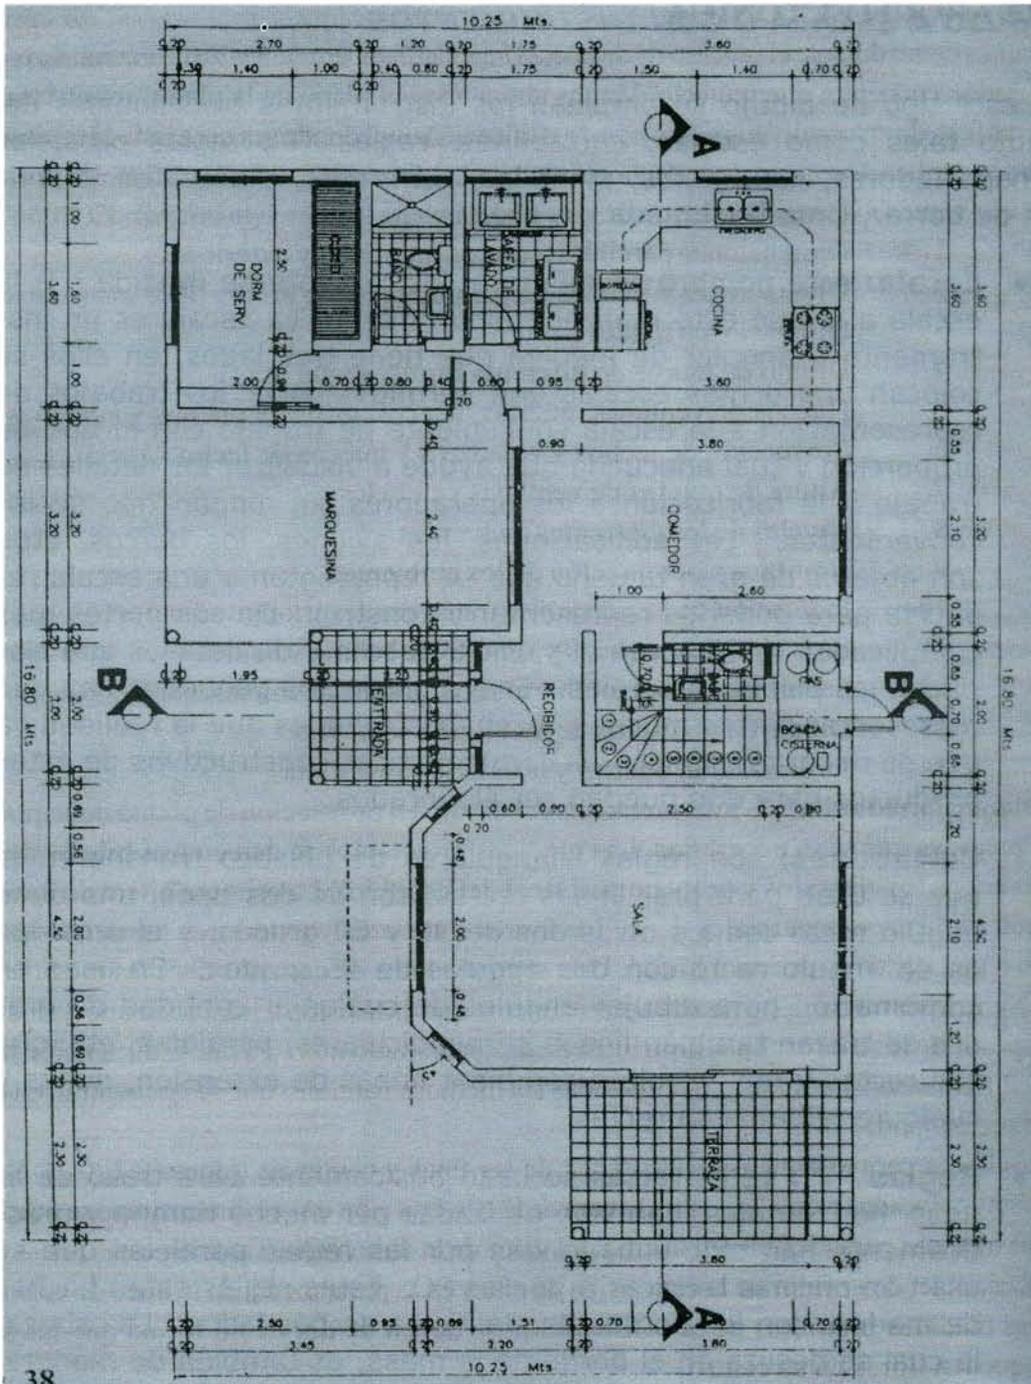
DIBUJO CON INSTRUMENTOS DE UNA PLANTA DIMENSIONADA
